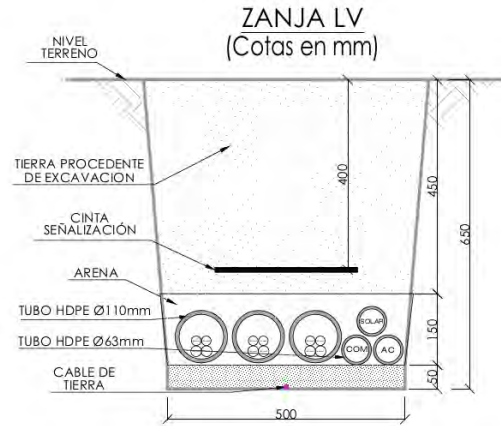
Sección tipo de zanja de la red de baja tensión subterránea.
